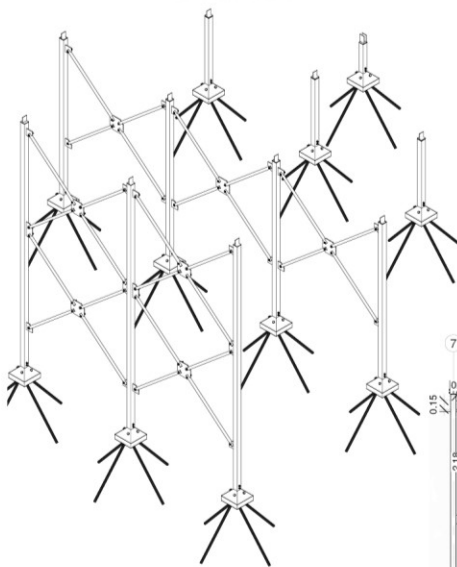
Lámina 07, planimetría de tipología A.<sup>306</sup>
